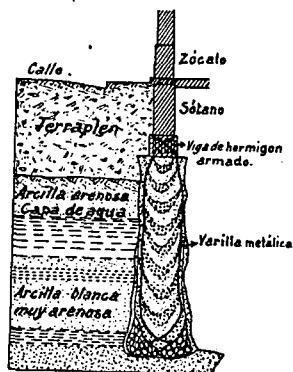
Unión de un pilón con una viga-salera de hormigón armado.
